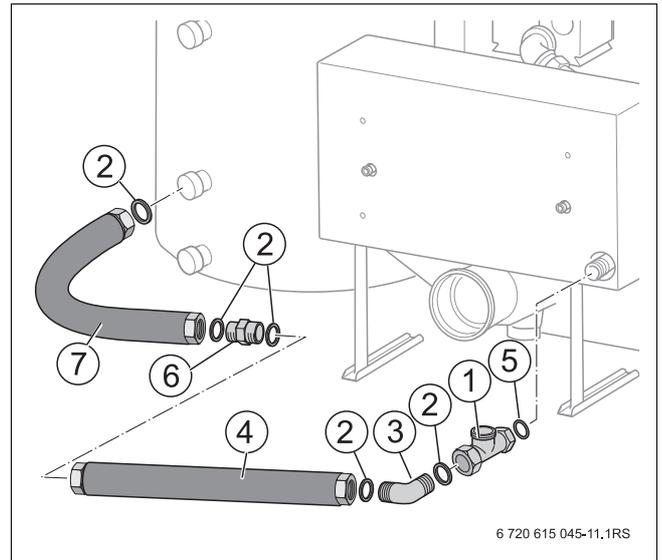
Rücklaufanschluss am Wärmetauscher montieren bei rechts nebenstehendem Warmwasserspeicher
